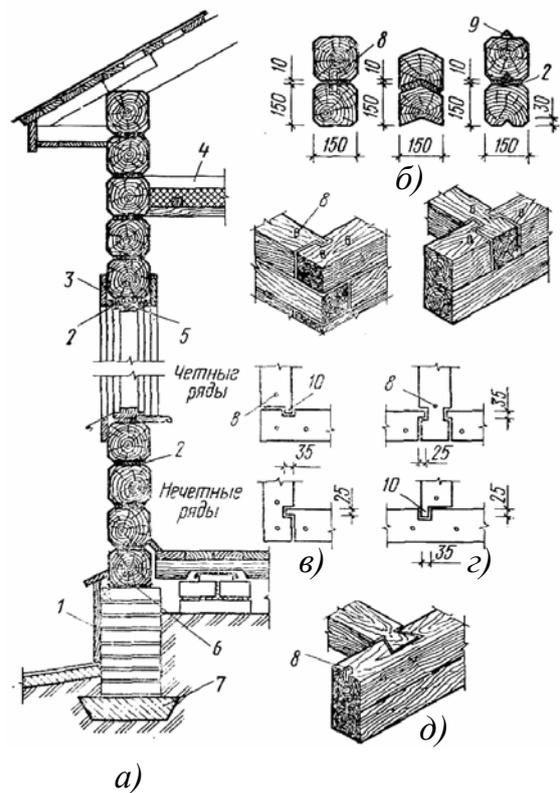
Конструкция брусчатых зданий: а) разрез по стене; б) варианты соединения брусьев сруба; в) сопряжения в углах; г) примыкание внутренней стены к наружной, д) опирание балок на стену врубкой «ласточкин хвост»; 1 – отделка кирпичного цоколя; 2 – мох или пакля; 3 – наличник; 4 – перекрытие; 5 – оконная коробка; 6 – гидроизоляция стены; 7 – песчаная подушка; 8 – вставной шип или нагель; 9 – нашивная рейка; 10 – коренной шип
